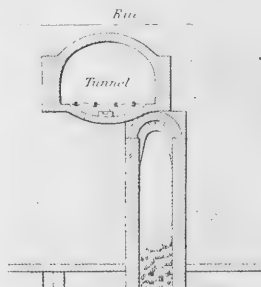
Exemple d'un mur de tunnel soutenu par la voûte d'un puits inférieur.
